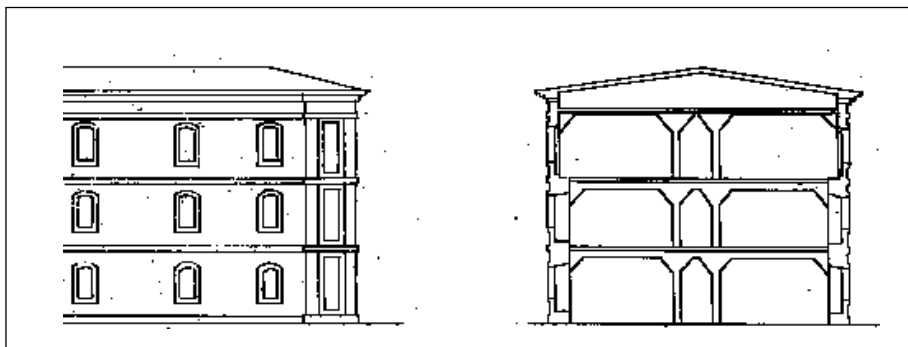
Projecte Bonell. Detall de façana i secció d'un dels edificis modificats de la plaça d'Armes.
